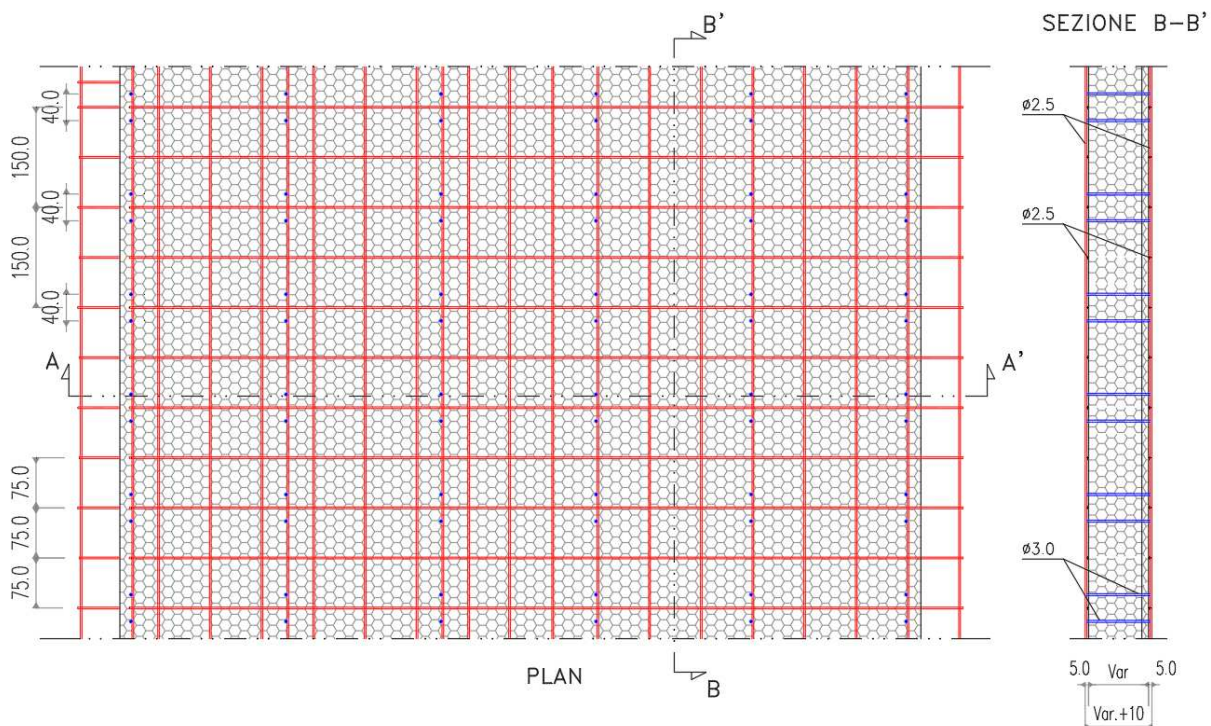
Planimetria e sezione della disposizione delle reti metalliche e connettori
